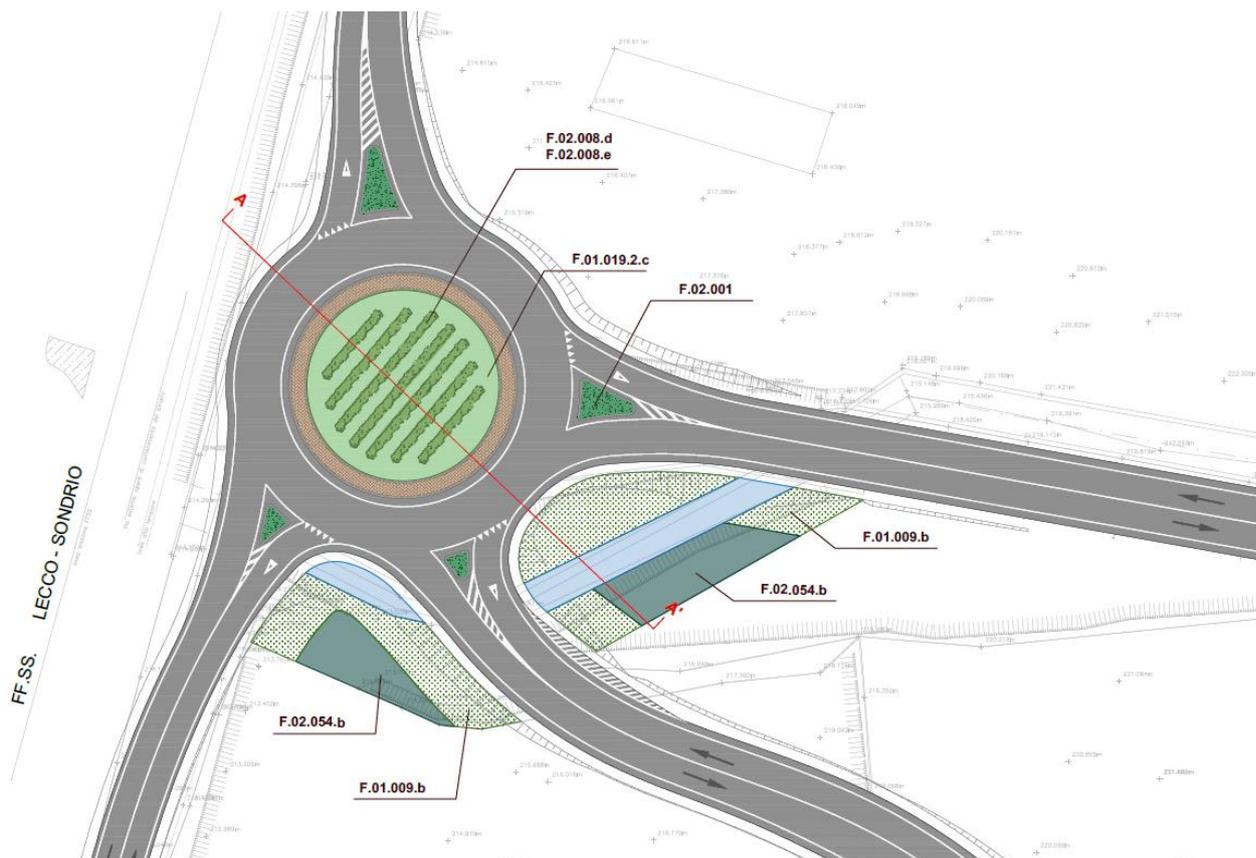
Stralcio Planimetria generale interventi di sistemazione a verde e inserimento paesaggistico/ambientale (area rotonda di progetto)
